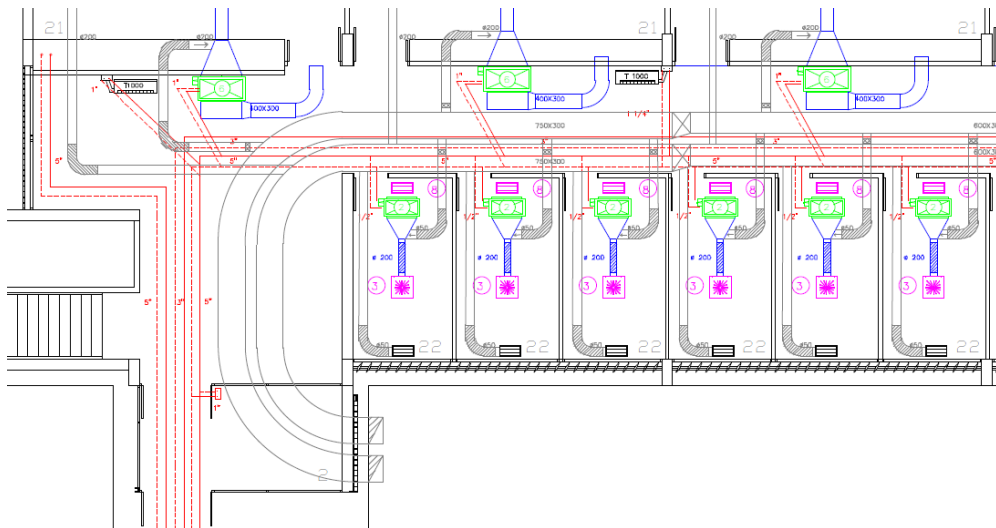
Vista de la climatizadora del DIM en la planta baja. Fuente: Elab. propia.
